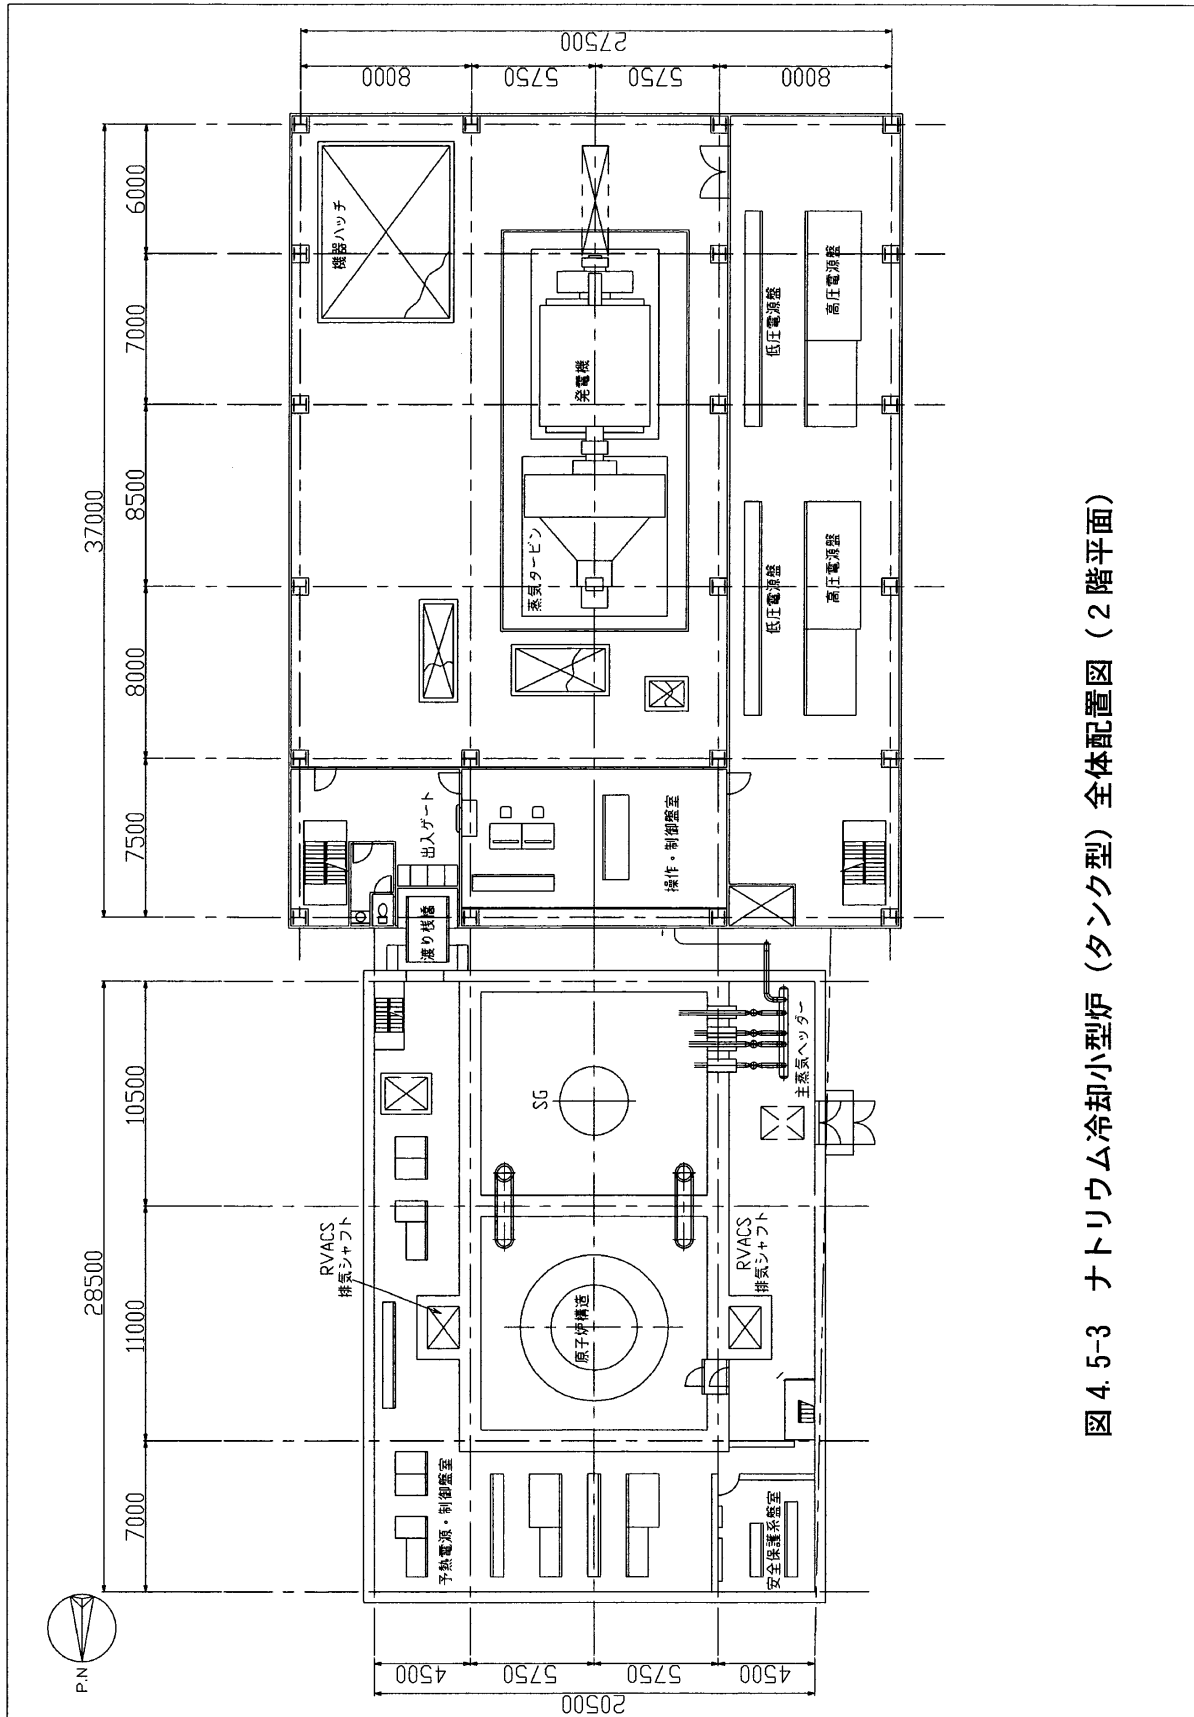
ナトリウム冷却小型炉 (タンク型) 全体配置図 (2階平面)
